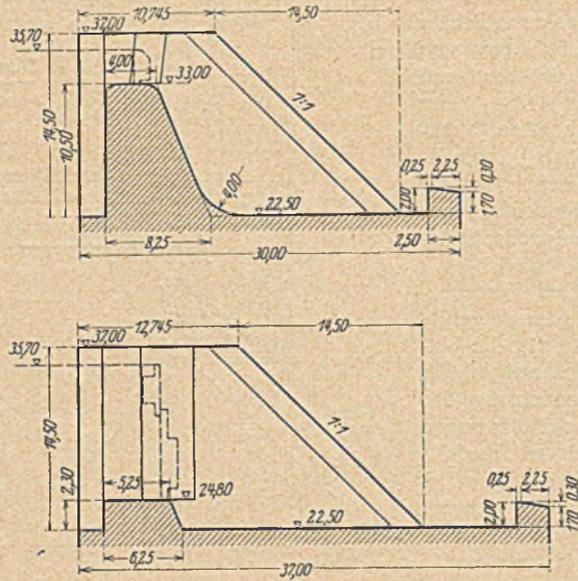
und 7. Längsschnitt durch die Überfall- und Grundabläßöffnungen des verbesserten, endgültigen Entwurfes.
